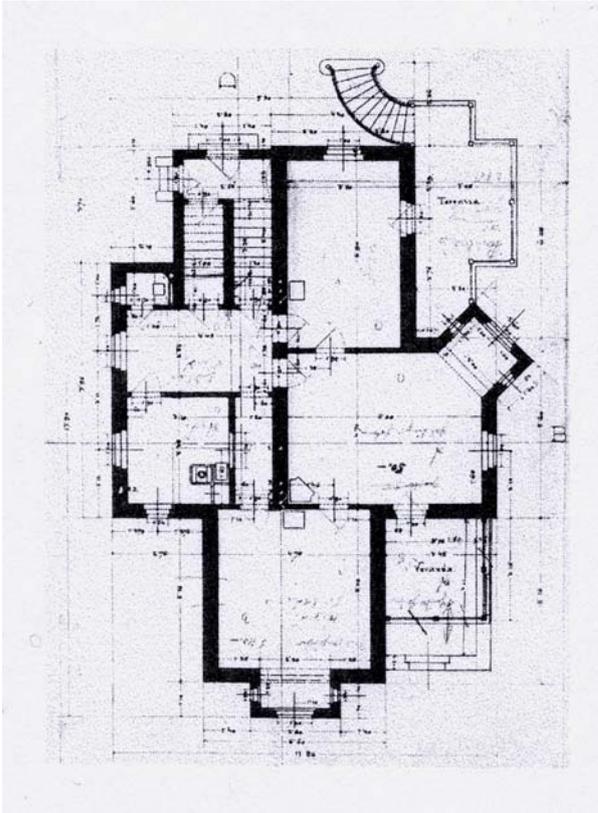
Villa Helenenstraße 45 in Baden. Grundriss. 1888. Einreichplan.
